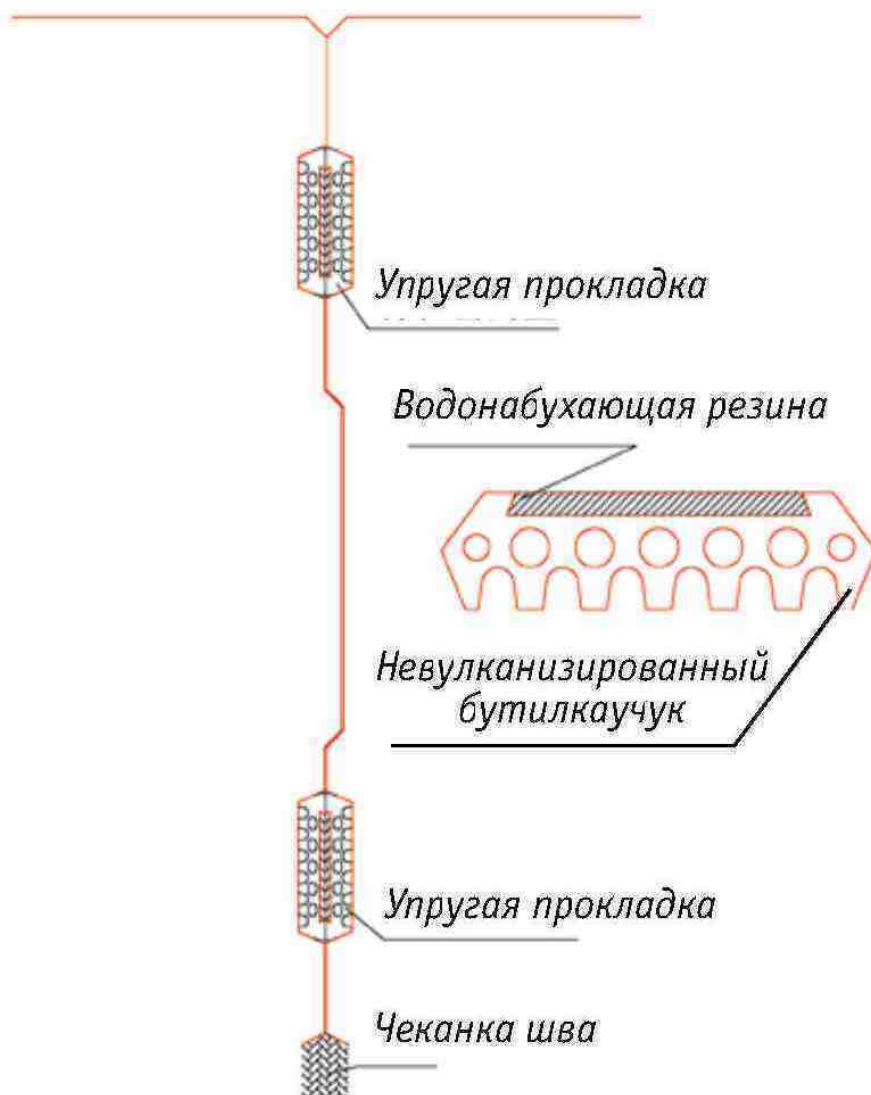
Две уплотнительные прокладки для гидроизоляции
